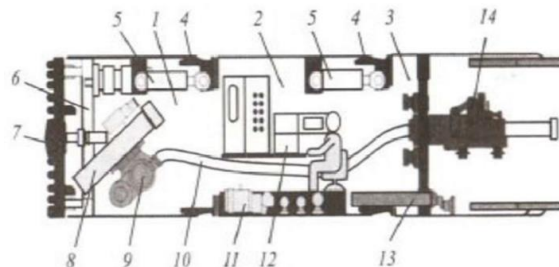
Конструктивная схема щитовой машины с шарнирным корпусом первого вида
